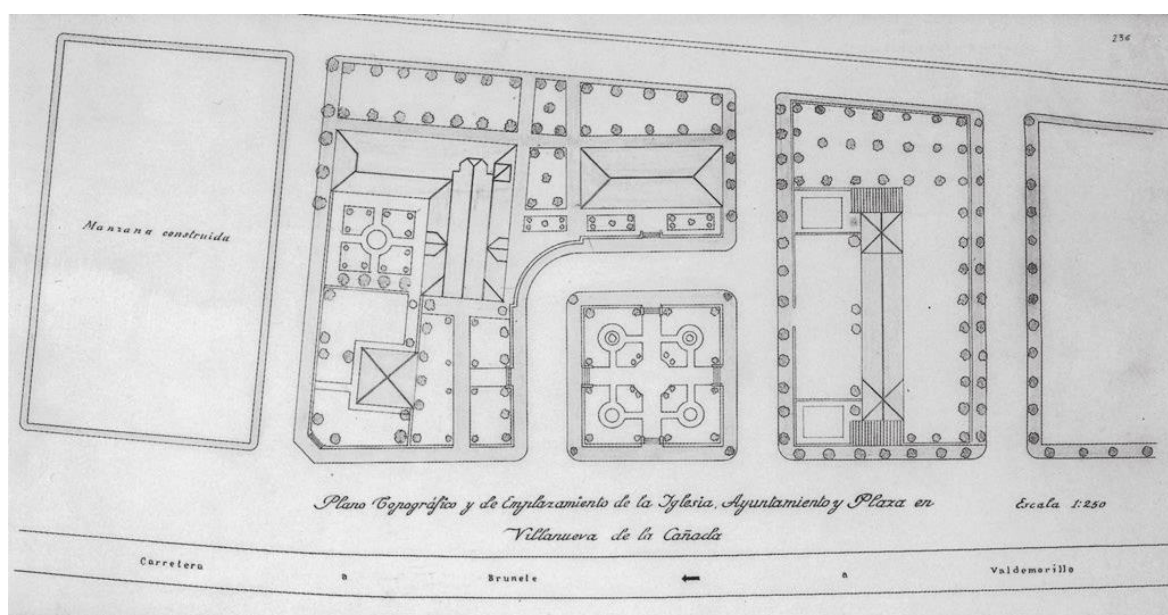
Proyecto de ordenación de la Plaza Mayor. Fuente: Archivo General de la Administración.
